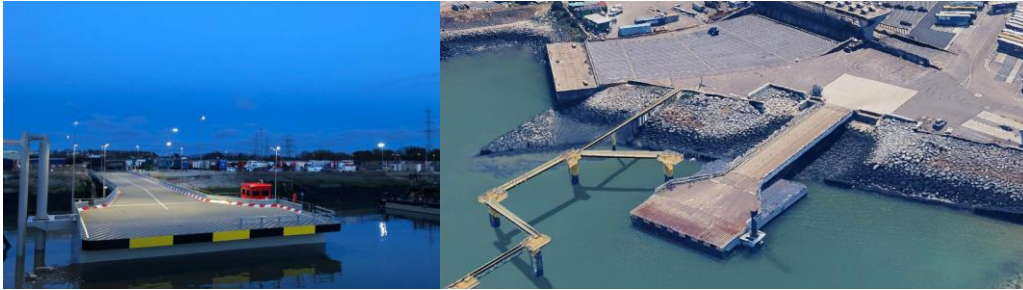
Roro Linkspan dans le port de Heysham : Installation roulante à ponton simple, avec pont d'accès soutenu par un ponton ⁵²
